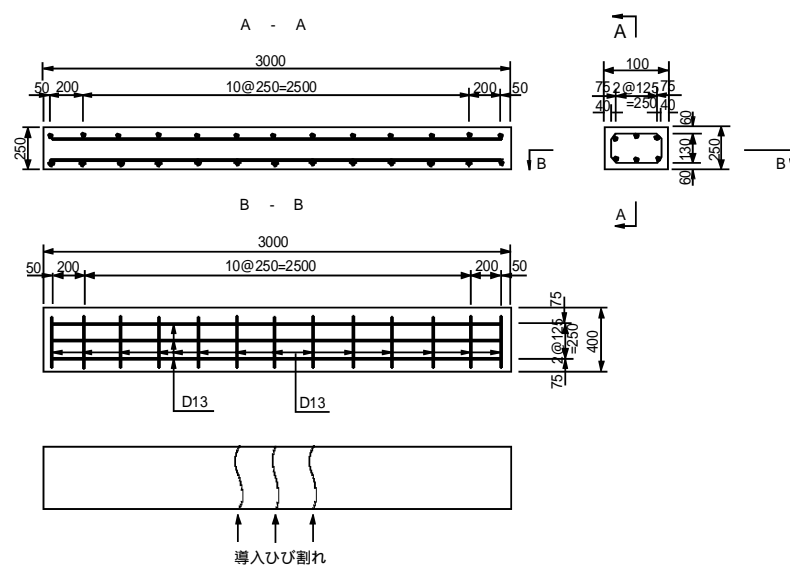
供試体寸法、配筋および導入ひび割れの模式
